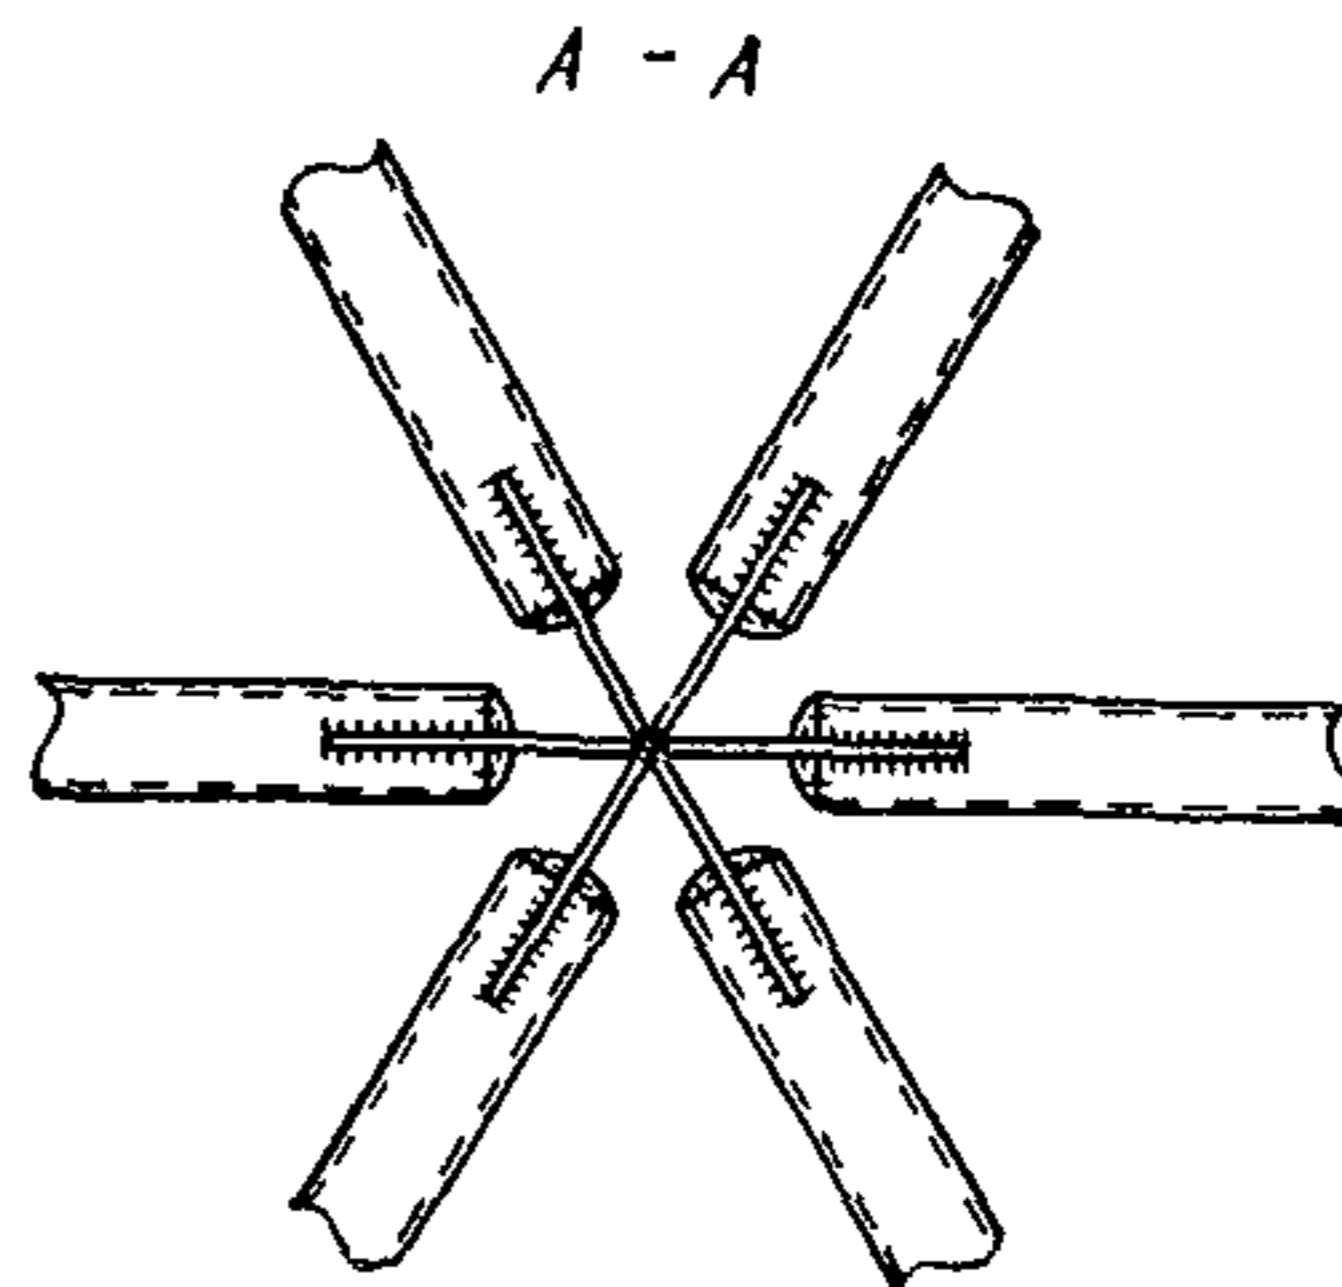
Узел сопряжения шести ферм, идущих в трех направлениях, осуществляемый с применением электрошлаковой сварки
